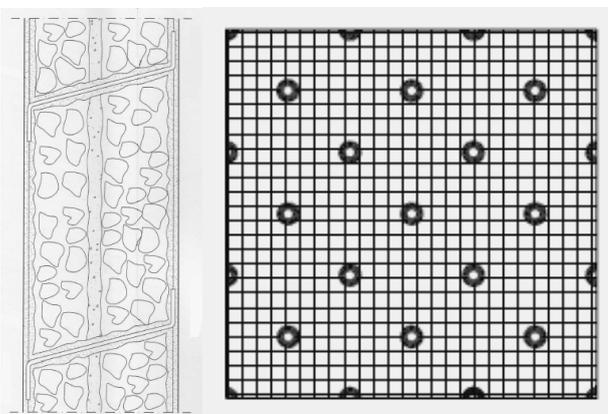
Corte esquemático da parede com reboco armado e esquema de ligadores em quincôncio
